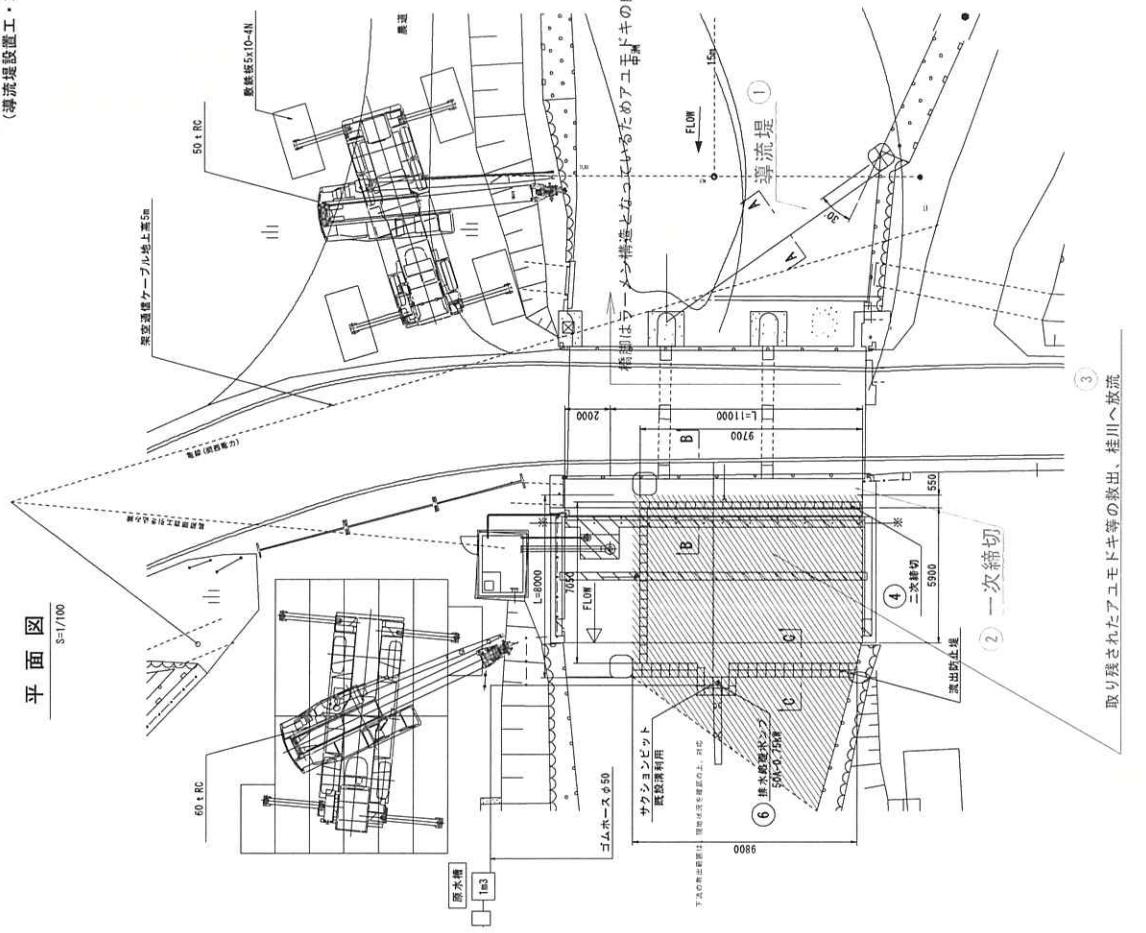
導流堤設置工、左岸締切工の施工要領図
